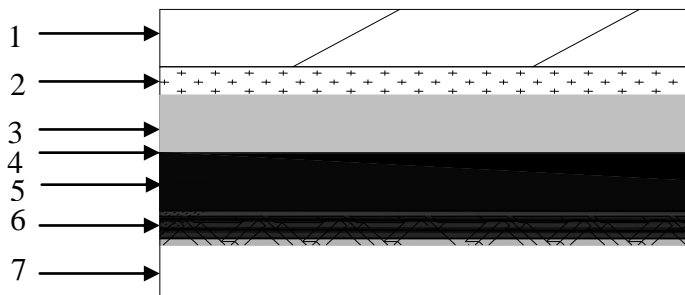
a : Coupe transversale du plancher terrasse inaccessible.
